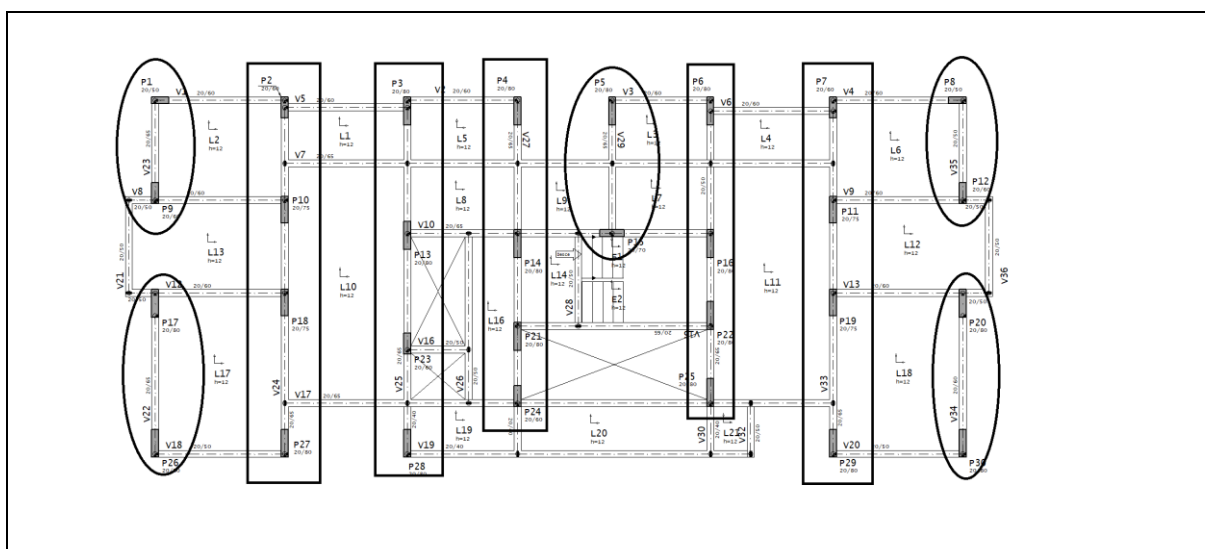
Planta de fôrma do pavimento Tipo - Modelo Estrutural com Pórticos de contraventamento na direção “x”
